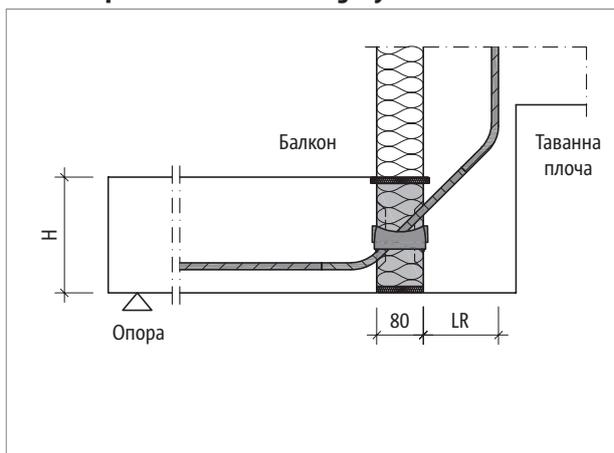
Schöck Isokorb® T тип QP-WO: Свързване със стена нагоре с външна изолация
